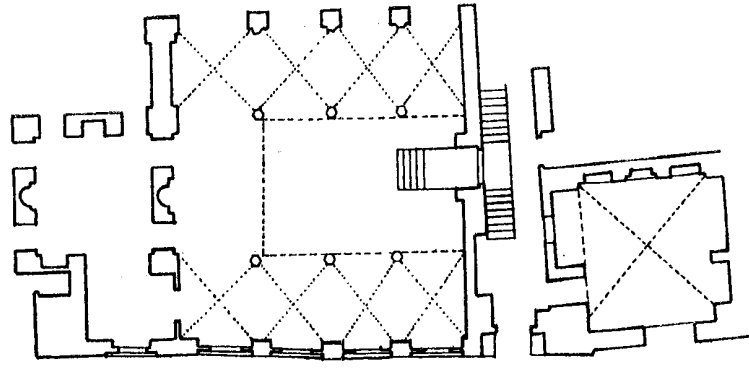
مسقط أفقي لجامع محمود محرم بالقاهرة .
